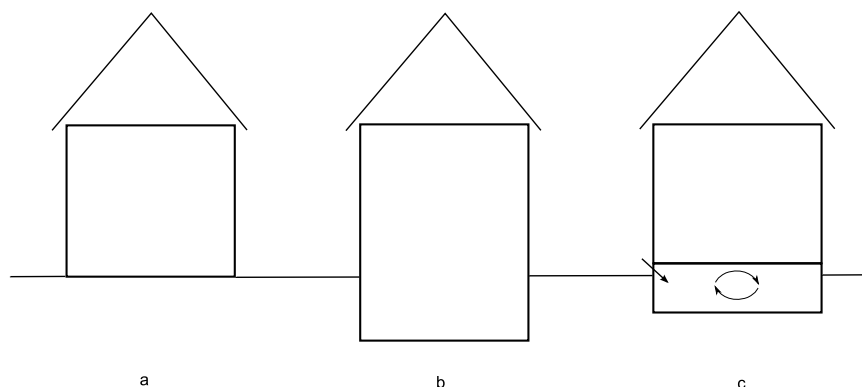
Types de fondations : a) dalle reposant directement sur le sol, b) dalle posée dans le sol, c) galerie
